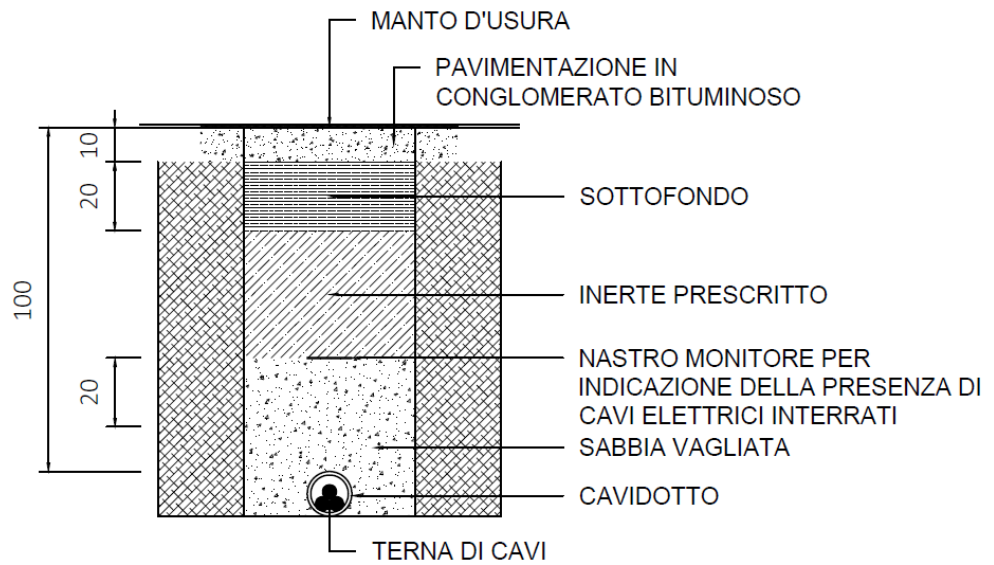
Sezione tipo scavo posa cavidotto su strada asfaltata
